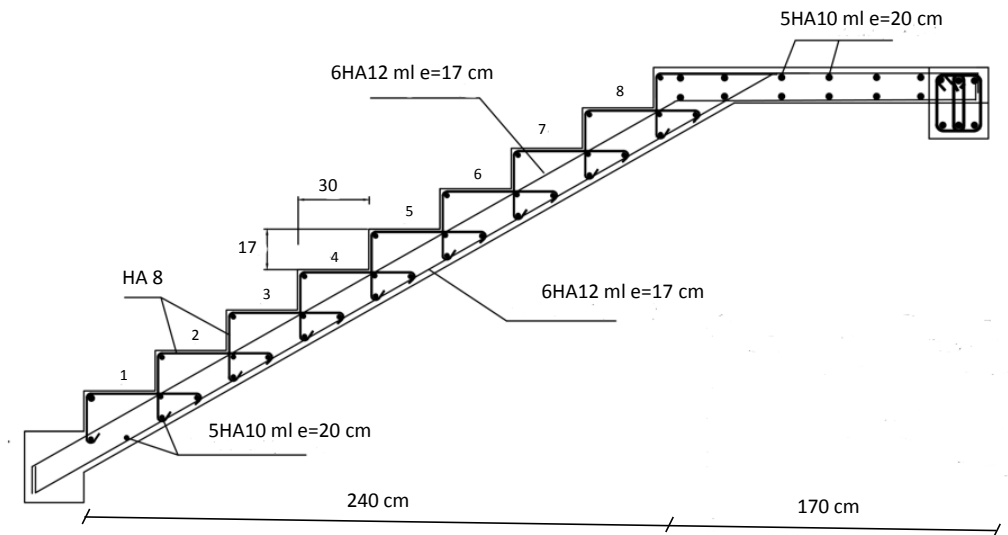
Schéma de ferrailage de l'escalier étage courant.
